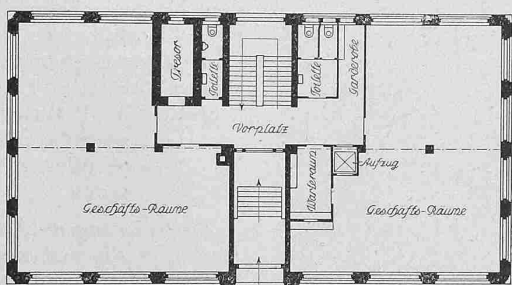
Geschäftshaus J. G. Nef & Cie. — Grundriss 1 : 400.
